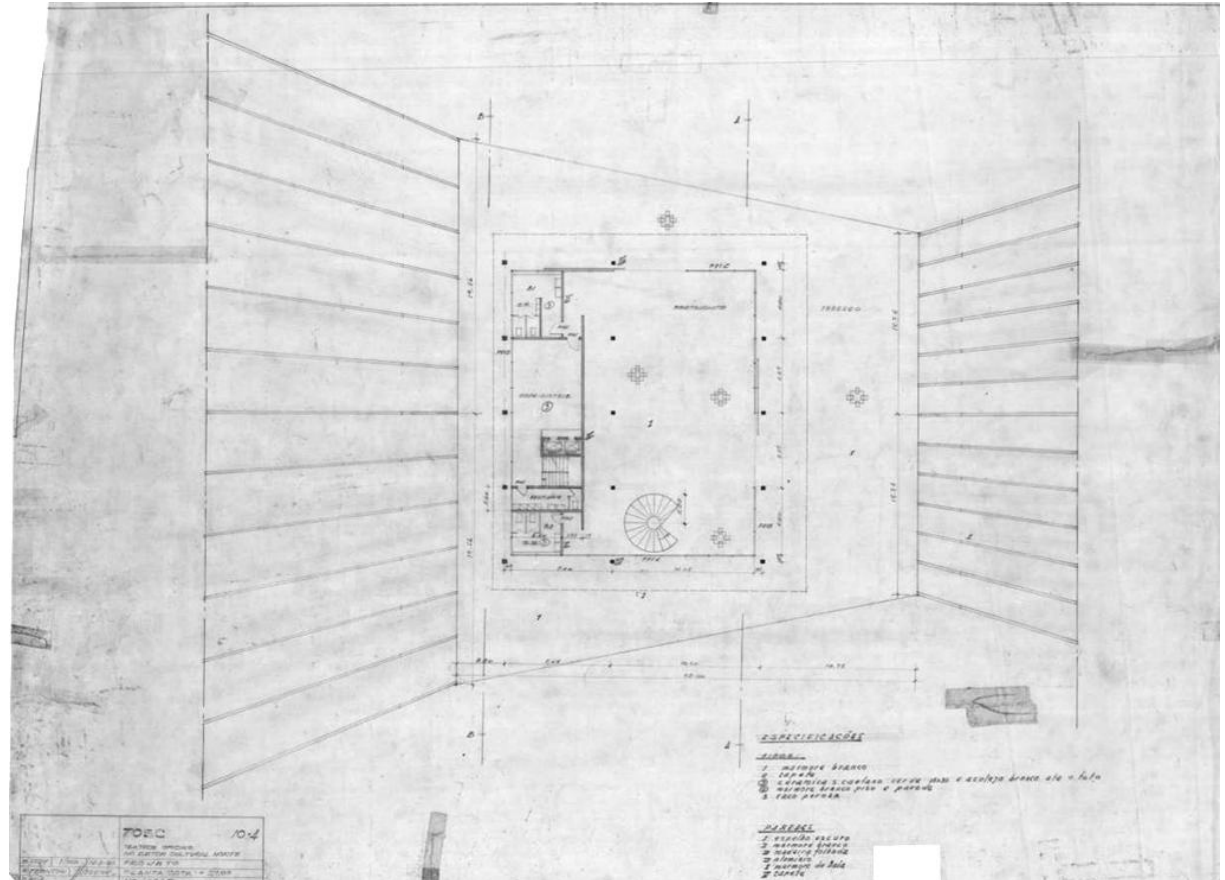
Planta Baixa, 4º Pavimento (1960). Carimbo: NOVACAP, TOSC 10.4. Conteúdo: Planta cota +21,00. Desenhista: R. Frontini. Data: 10/03/60. Fonte: ARPDF.
